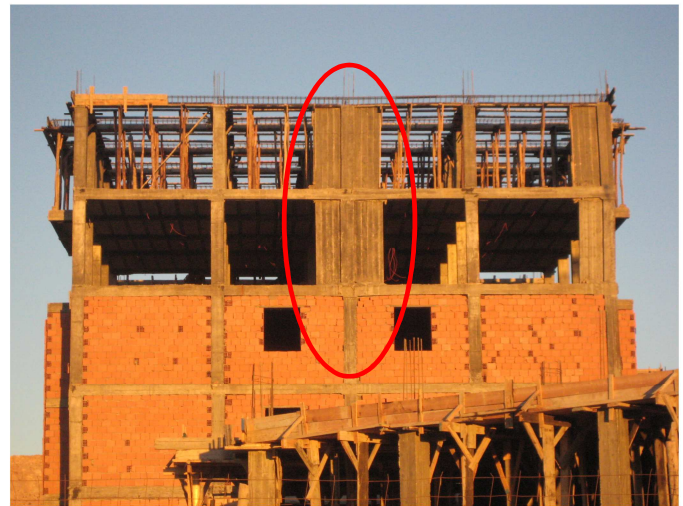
Mauvaise disposition des voiles (discontinuité)
